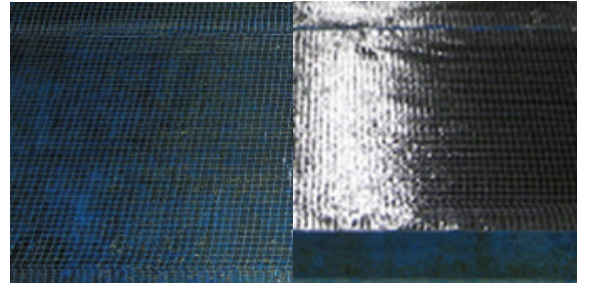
1層目（橋軸直角） 写真-5 2層目（橋軸方向）
